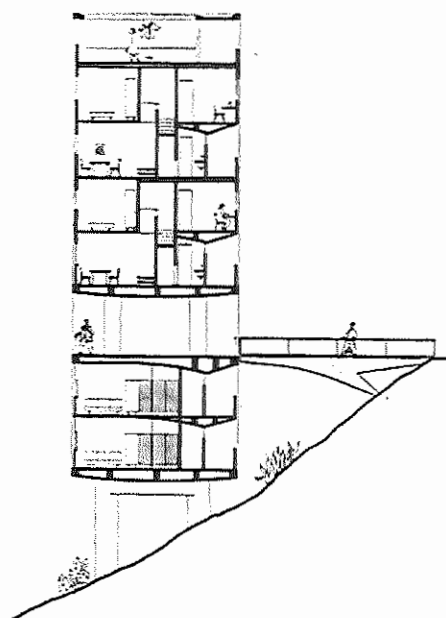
Corte transversal do bloco principal. "O 1º e o 2º pavimentos serão ocupados por apartamentos simples, isto é de dormitório e sala; o 3º é o acesso (rua elevada); o 4º, o 5º, o 6º e o 7º pavimentos serão ocupados por apartamentos duplex e o 8º pavimento servirá de terraço e lavanderia."
